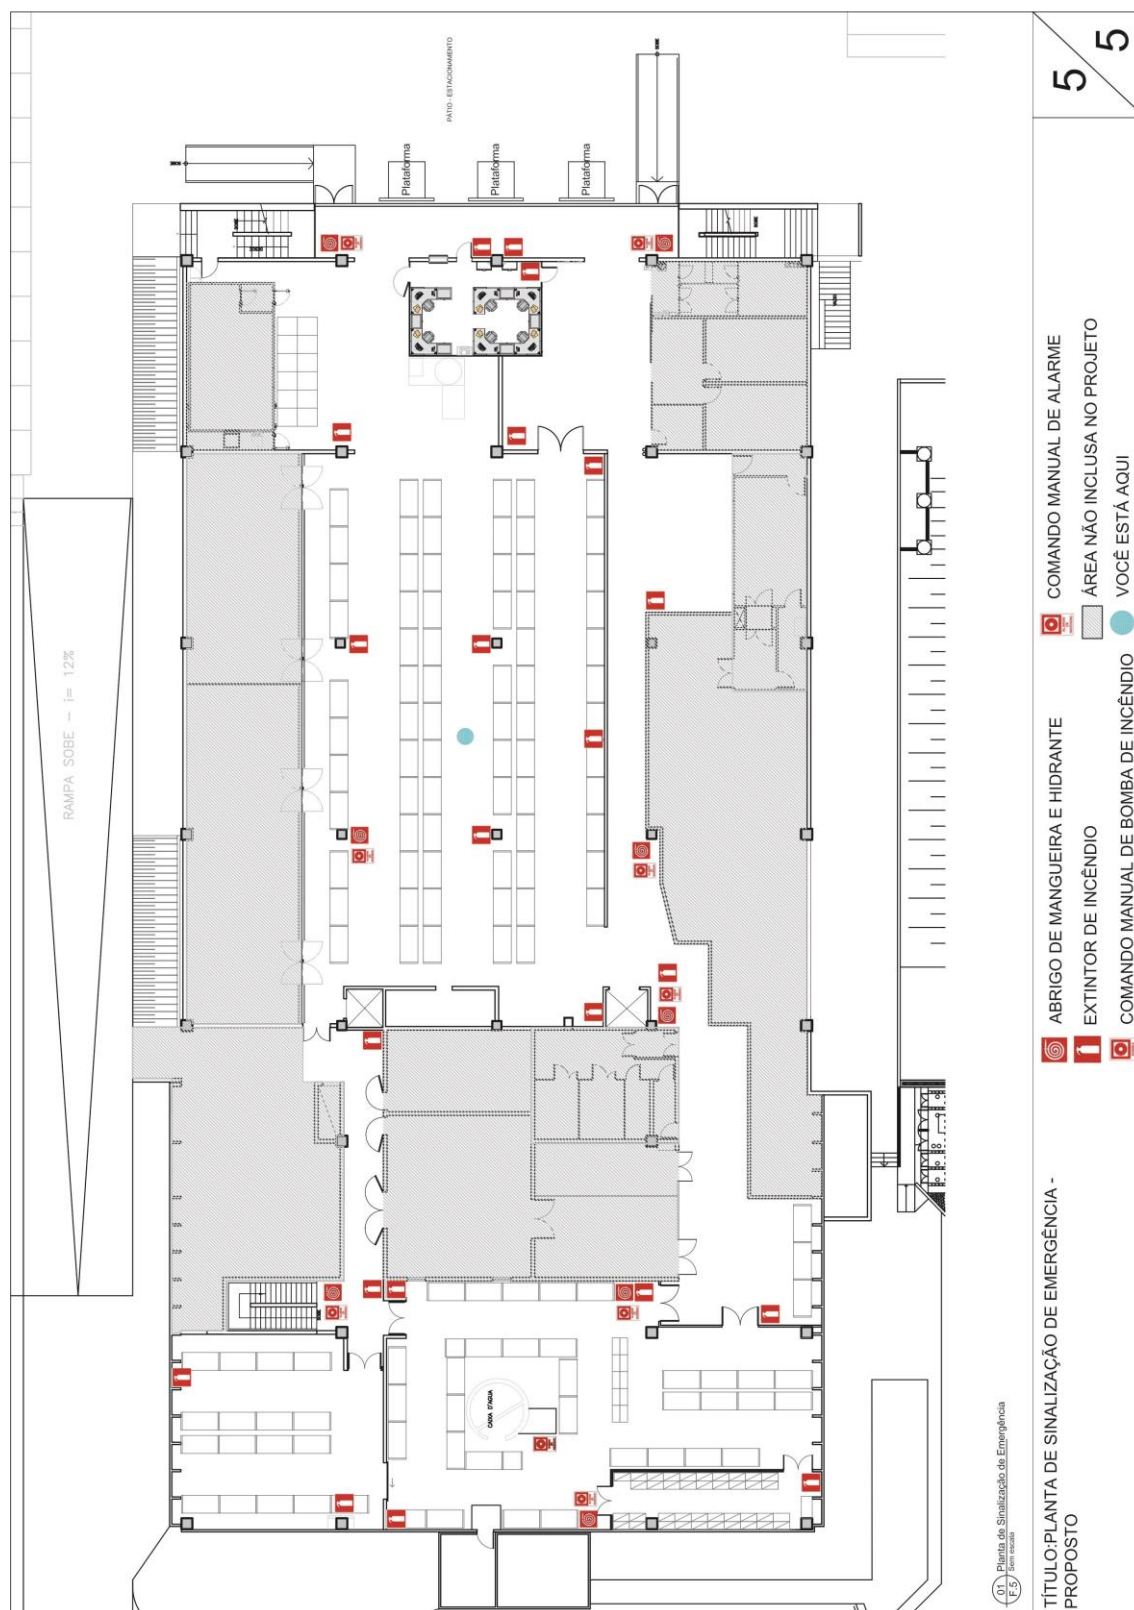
Planta de equipamentos de emergência - proposta, São Paulo – SP.
